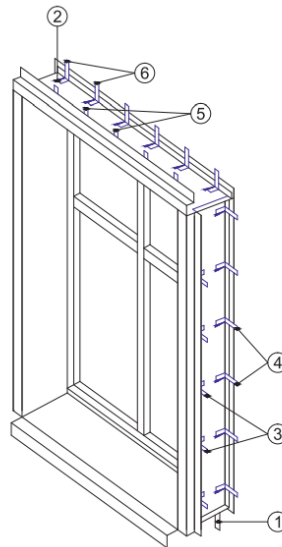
Схема установки короба віконного обрамлення: 1 - сталеві заклепки; 2 – саморіз; 3 - милиця для кріплення до вертикальних напрямних (крок не більше 600 мм); 4 - милиця для кріплення до стіни (крок не більше 600 мм); 5 - милиця для кріплення до кронштейнів (крок, рівний кроку кріплення кронштейнів); 6 - милиця для кріплення до стіни (смуга оцинкована сталь 40x2 мм, крок не більше 400 мм). Матеріал: оцинкована сталь (лист 5 > 0,55 мм).
